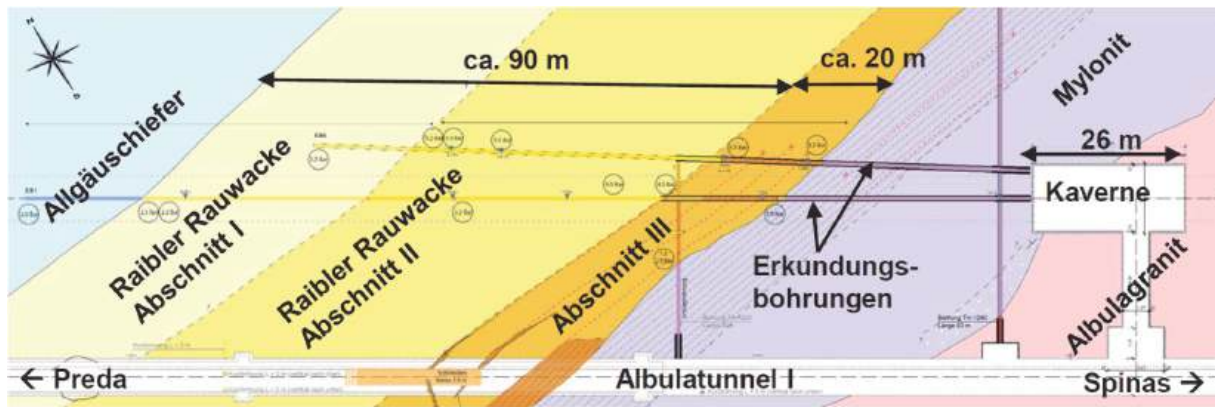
Raibler Rauwacke – Erkundung in der Achse Albulatunnel II (Grundriss)
